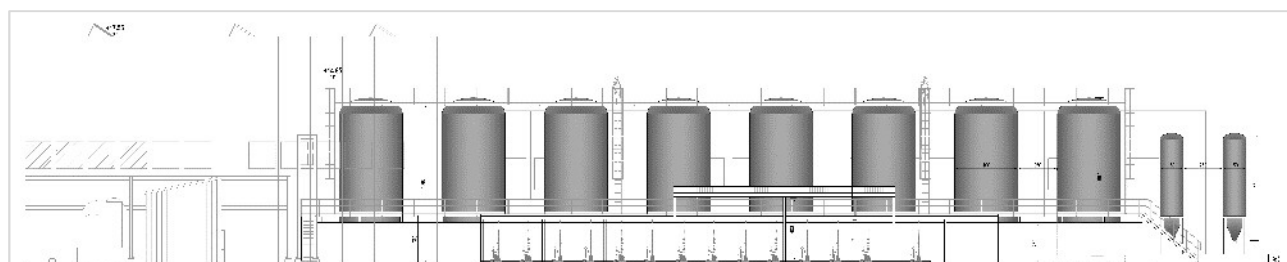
Vista in sezione dei serbatoi di stoccaggio sezione N9 (stralcio elaborato EI.55.00_CO 05 RA VA 00 D1 PL 55.00 - N9 PROSPETTI E SEZIONI)
